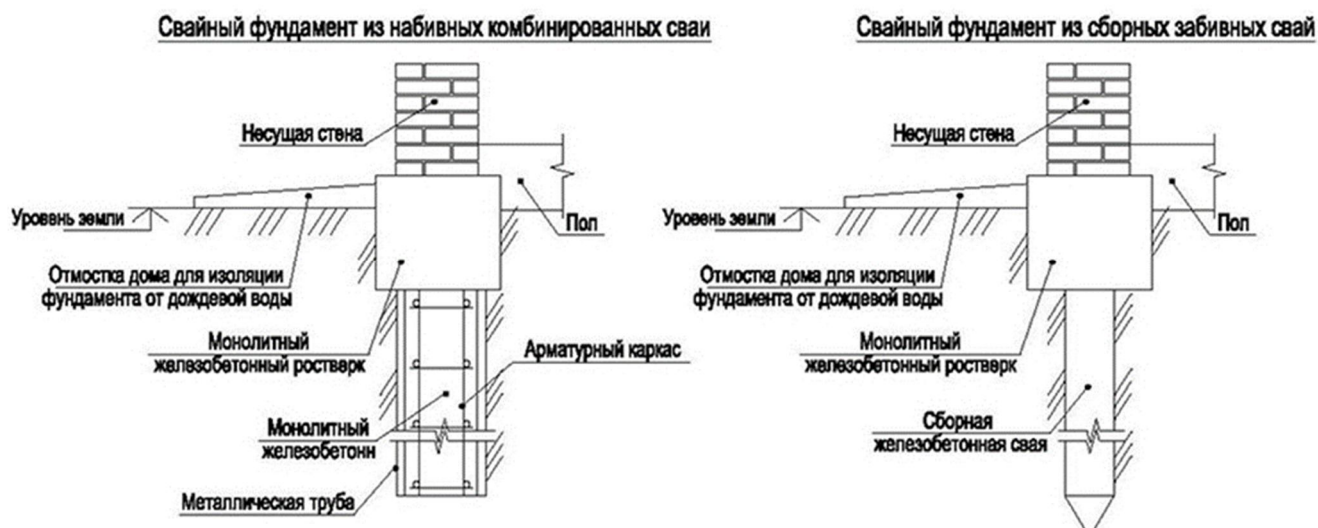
Схема свайного фундамента из набивных комбинированных свай
